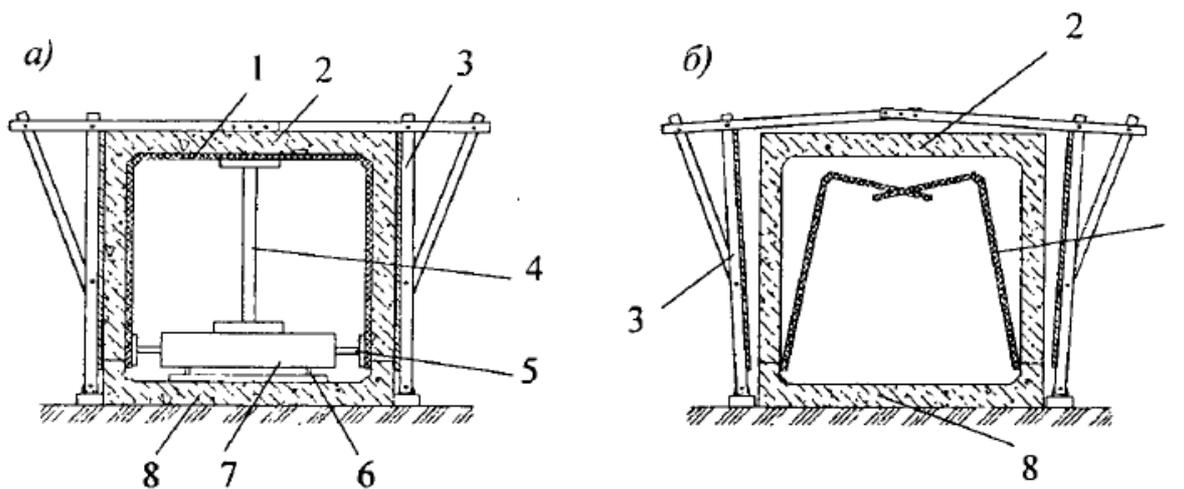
Катучая опалубка для бетонирования подземных коллекторов:
